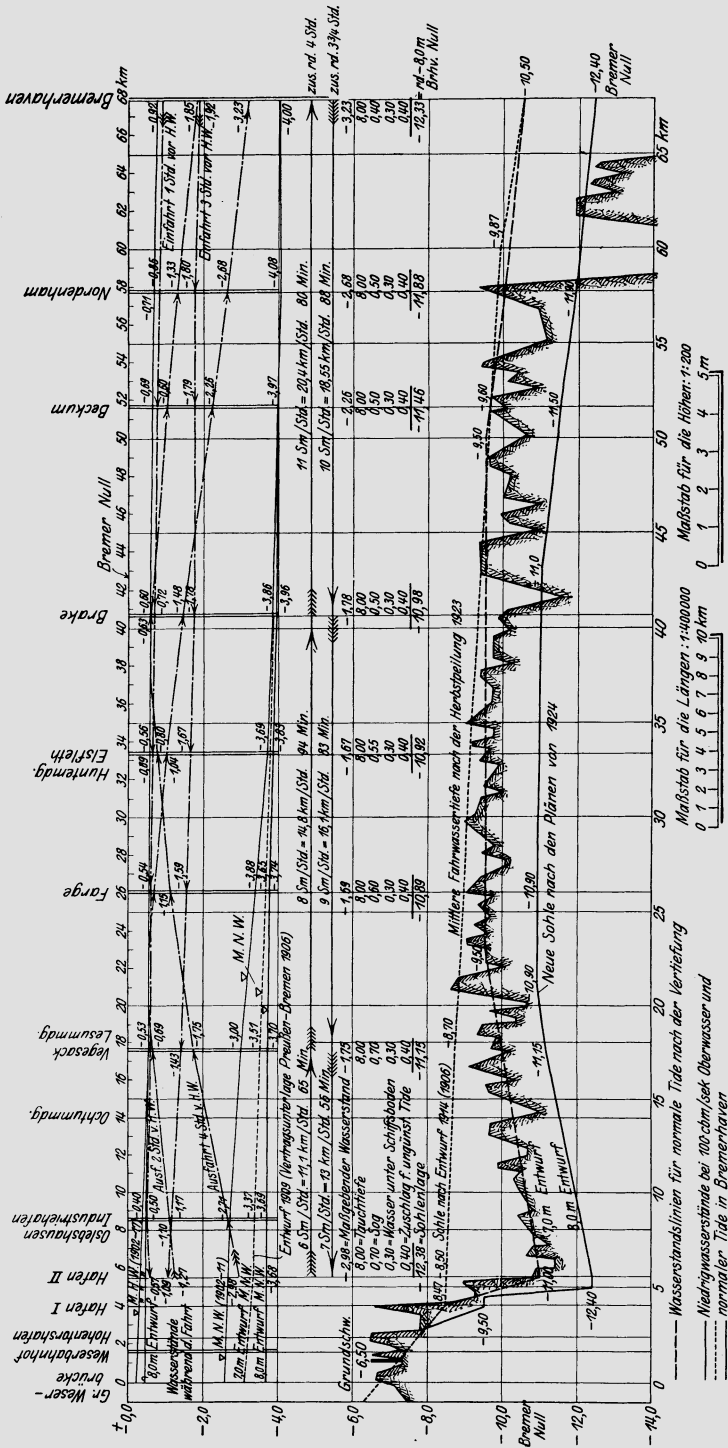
Längenprofil der Unterweser. Entwurf 1925.
